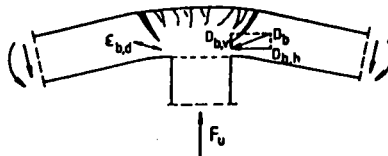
Druckstrebenkraft-Stauchung nach [N1]
